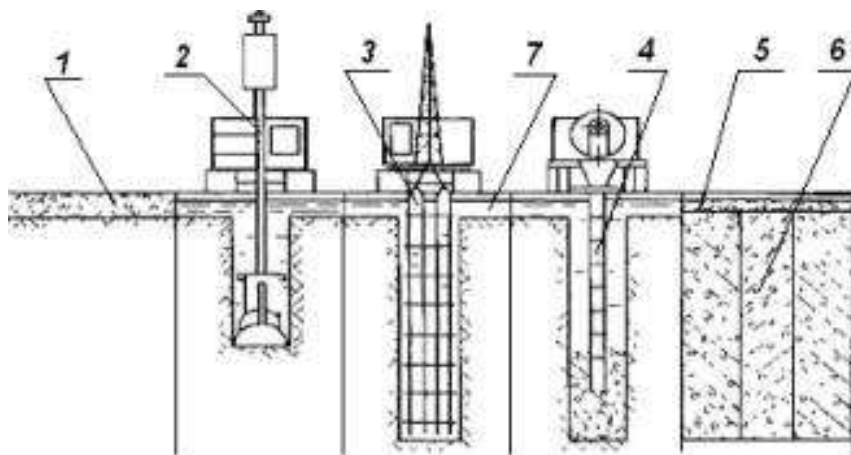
Схема будівництва підземної частини споруди методом «стіна в ґрунті»: 1 - форшахти; 2 - розробка ґрунту в траншейних захватках; 3 - установка армокаркаса; 4 - бетонування методом вертикально переміщуваної труби (ВПТ); 5 - пристрій обв'язувального пояса по периметру; 6 - готова стіна; 7 - глинистий розчин.
